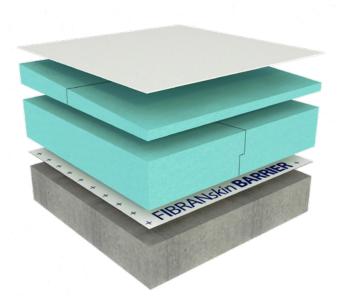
Tetto tradizionale con impermeabilizzazione a vista
